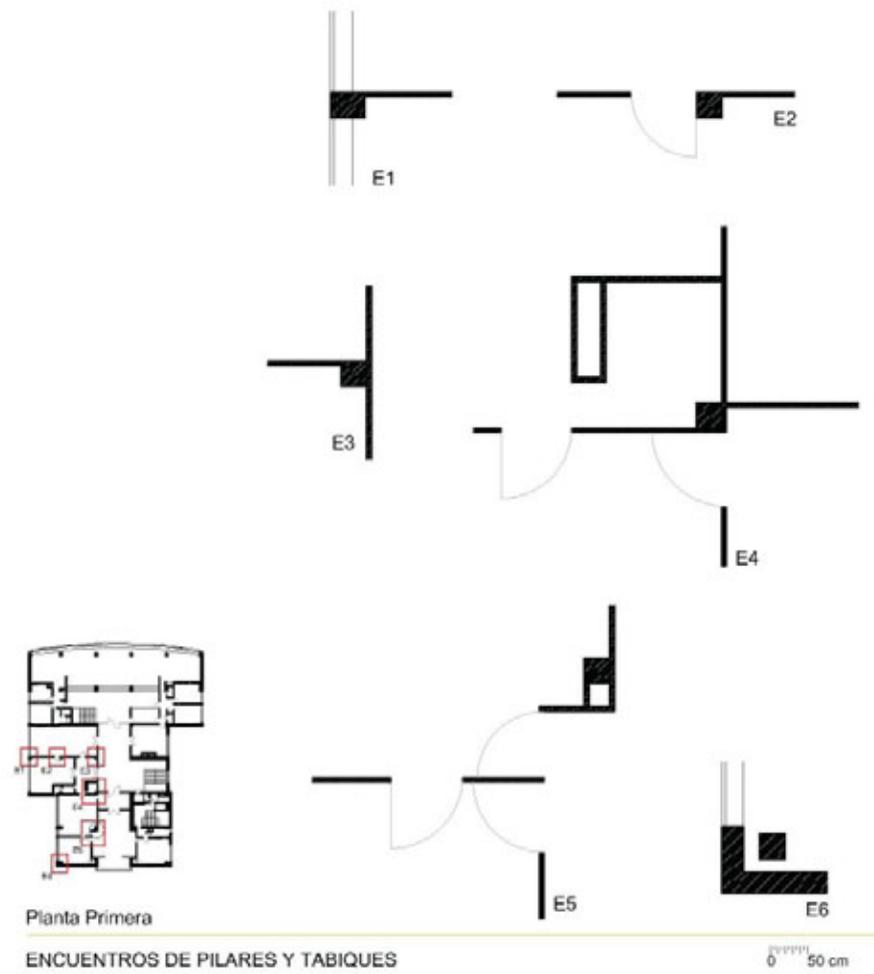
Encuentros de pilares y tabiques en planta primera. Santiago Barge.
